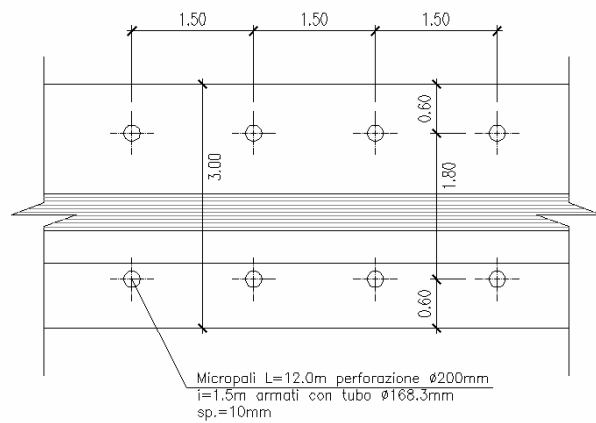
TIPO 3 e TIPO 4: disposizione planimetrica micropali
